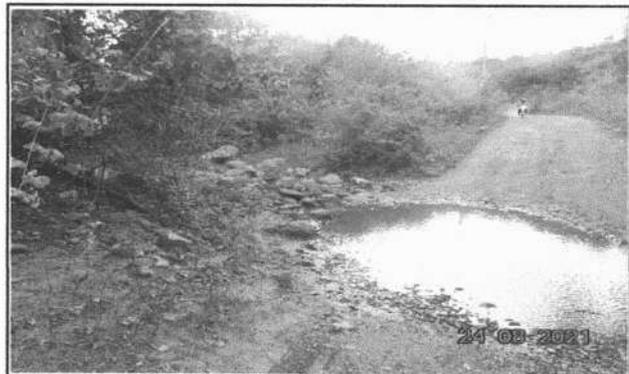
LOCAL DA CONSTRUÇÃO - BUEIRO
